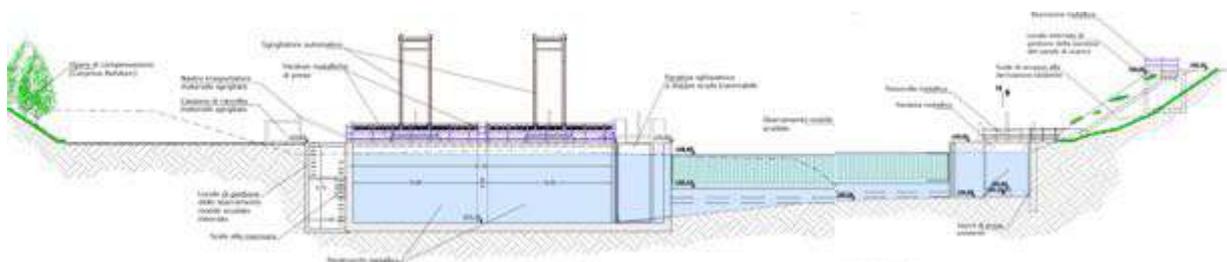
Sezione longitudinale turbina Kaplan "PIT"
